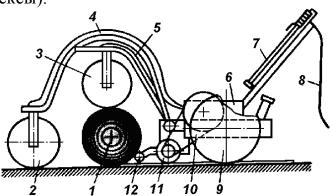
Схема кровельной установки для укладки и наклейки наплавленного рубероида безогневым способом
